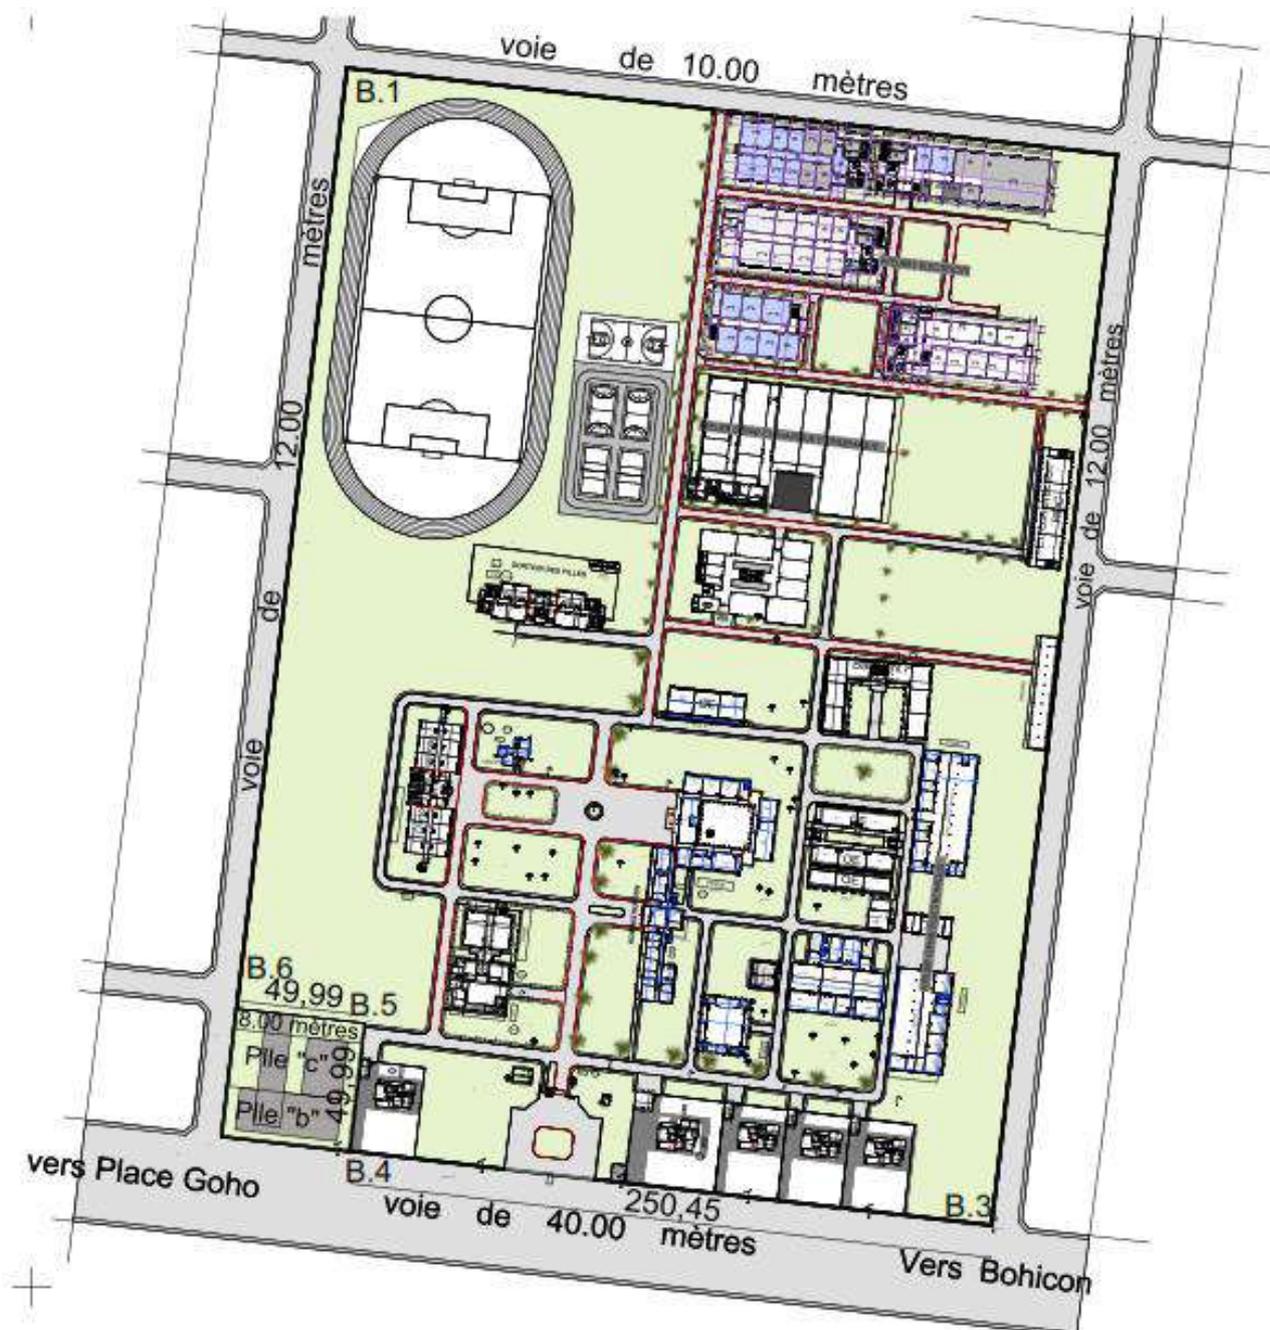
Plan de masse type de construction du Lycée Technique Professionnel de Bohicon
